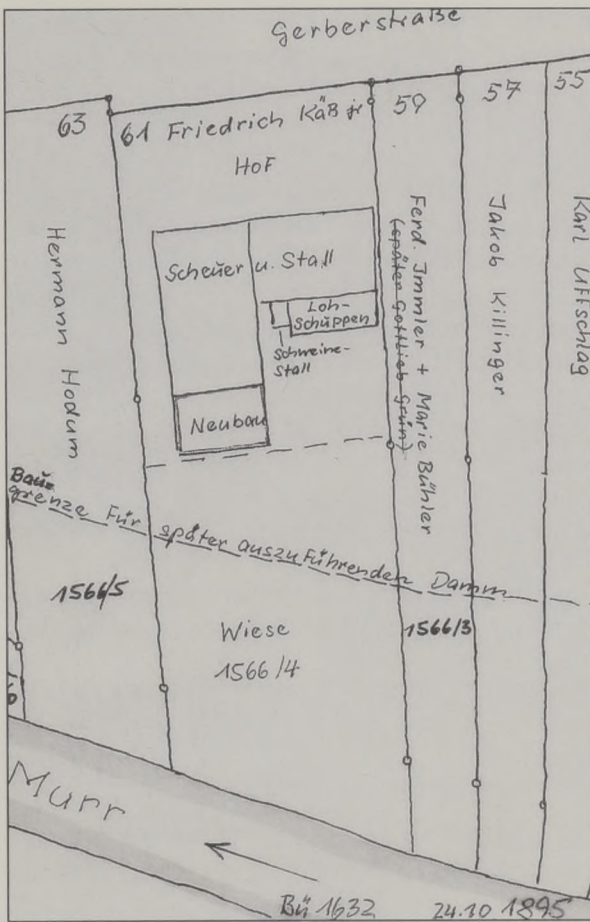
Lageplan mit den von Friedrich Kaess jun. auf der Parzelle 1566/4 (Gerberstraße 61) bis 1895 errichteten Gebäuden.
